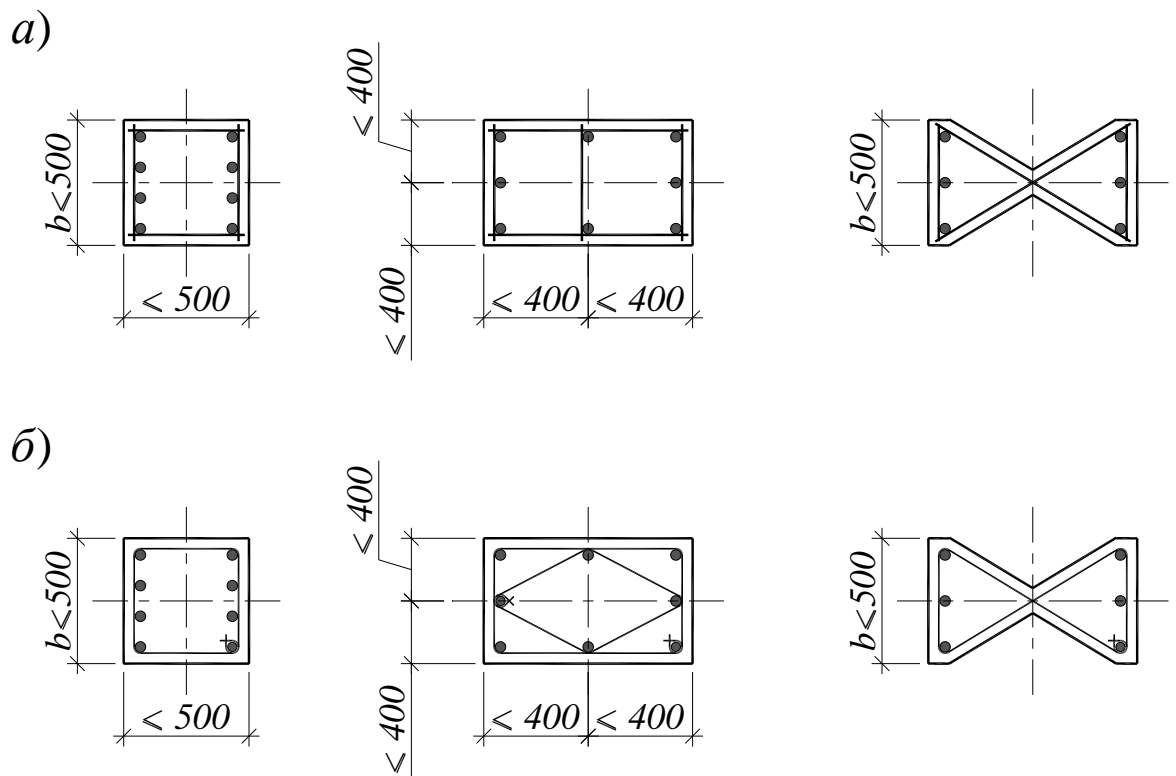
Армирование сжатых элементов: *а* – сварные каркасы; *б* – вязаные каркасы.
